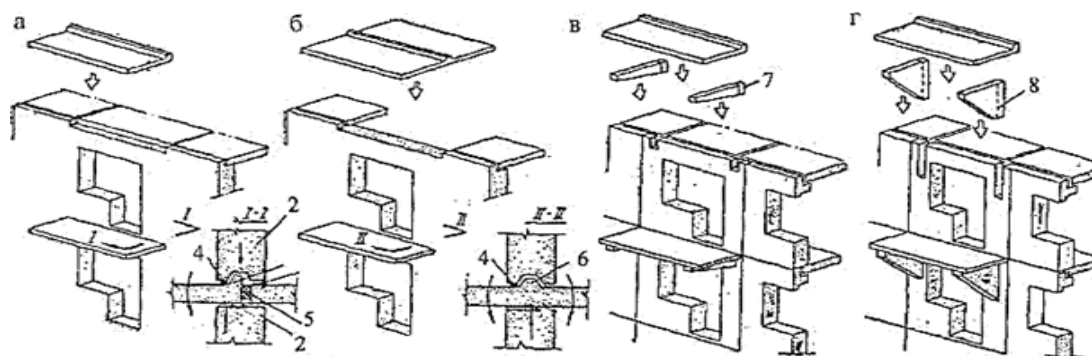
Схемы передачи изгибающего момента и вертикальных усилий от балконной плиты на конструкцию
